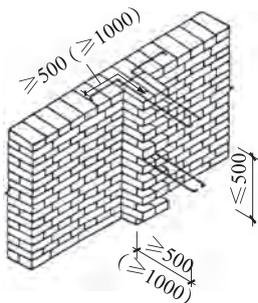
砌体直槎和拉结钢筋（单位：mm）
